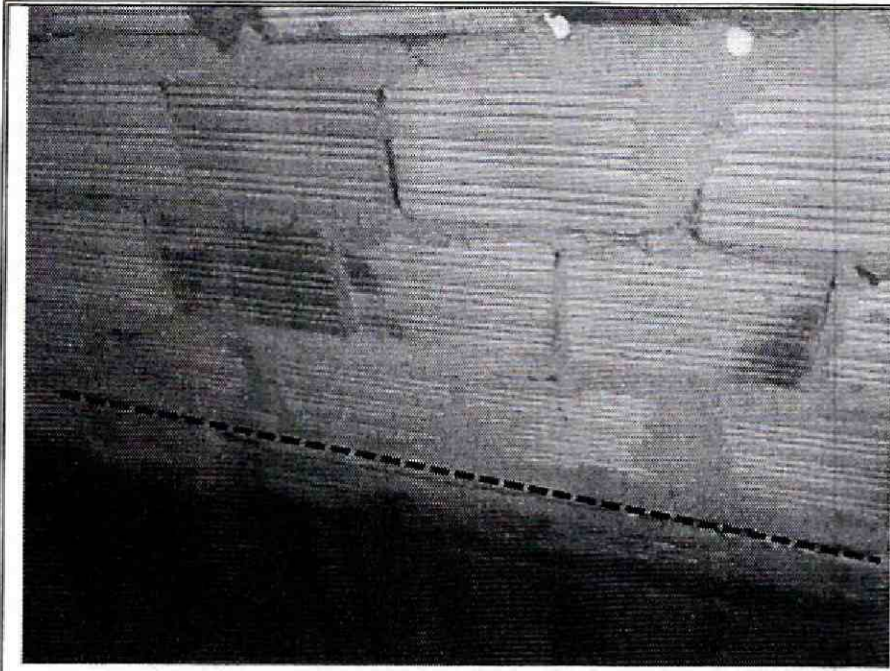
Presencia de fisuras, de tendencia horizontal, en el costado oriental del muro de cerramiento de la vivienda.
